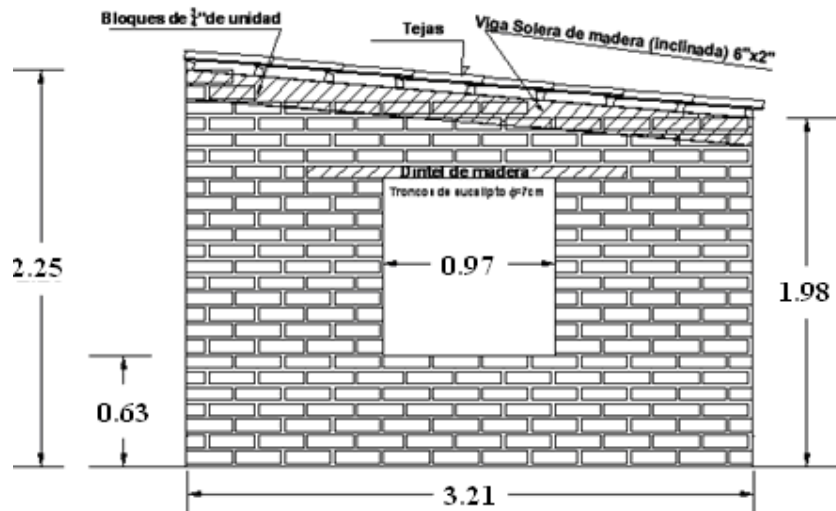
Elevación del muro Sur y alturas de los muros transversales.
